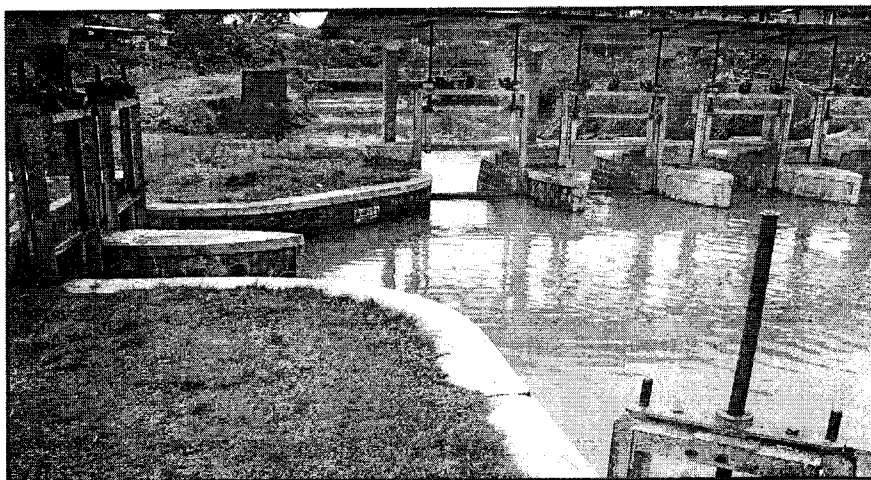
Bangunan bagi-sadap di irigasi Way Umpu Lampung (2005)
